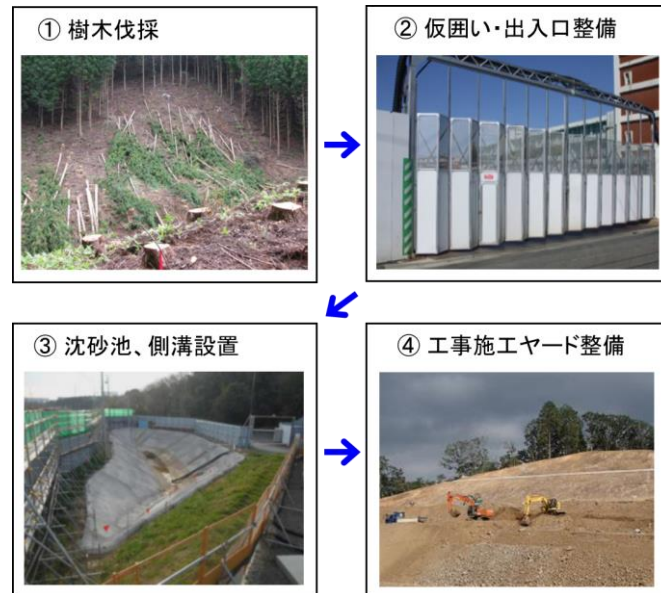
工事施工ヤード造成の施工手順（写真は類似工事の例）
